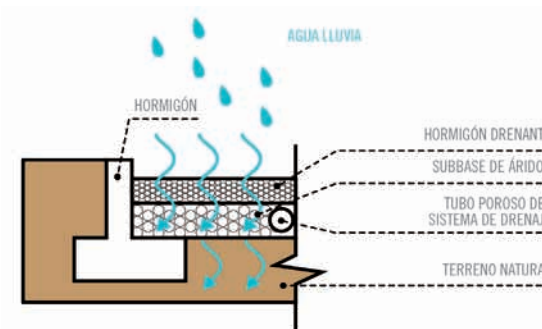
PAVIMENTO PERMEABLE CON ALMACENAMIENTO
